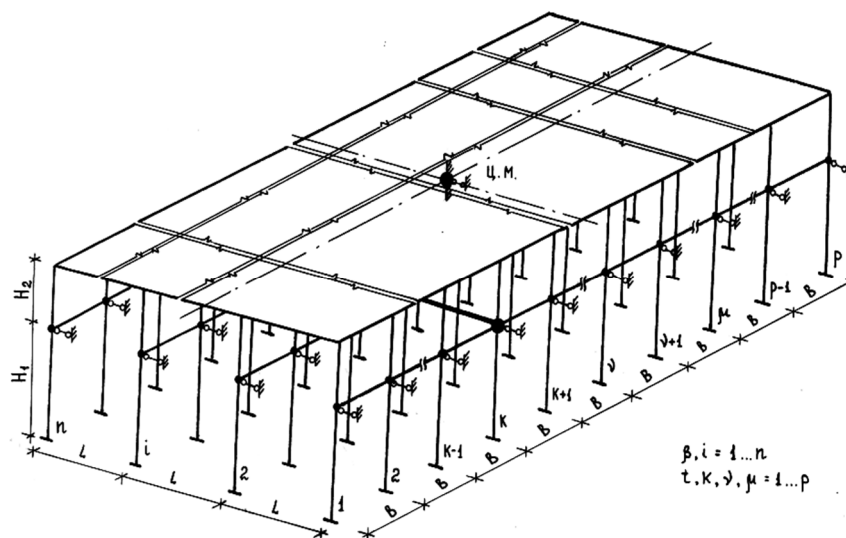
Расчетная схема одноэтажного промышленного здания с жестким в своей плоскости покрытием
